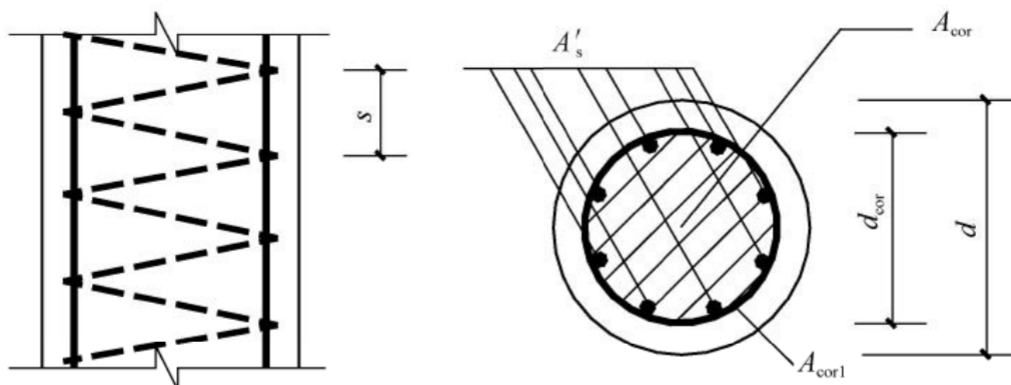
配置螺旋式间接钢筋的钢筋混凝土轴心受压构件
